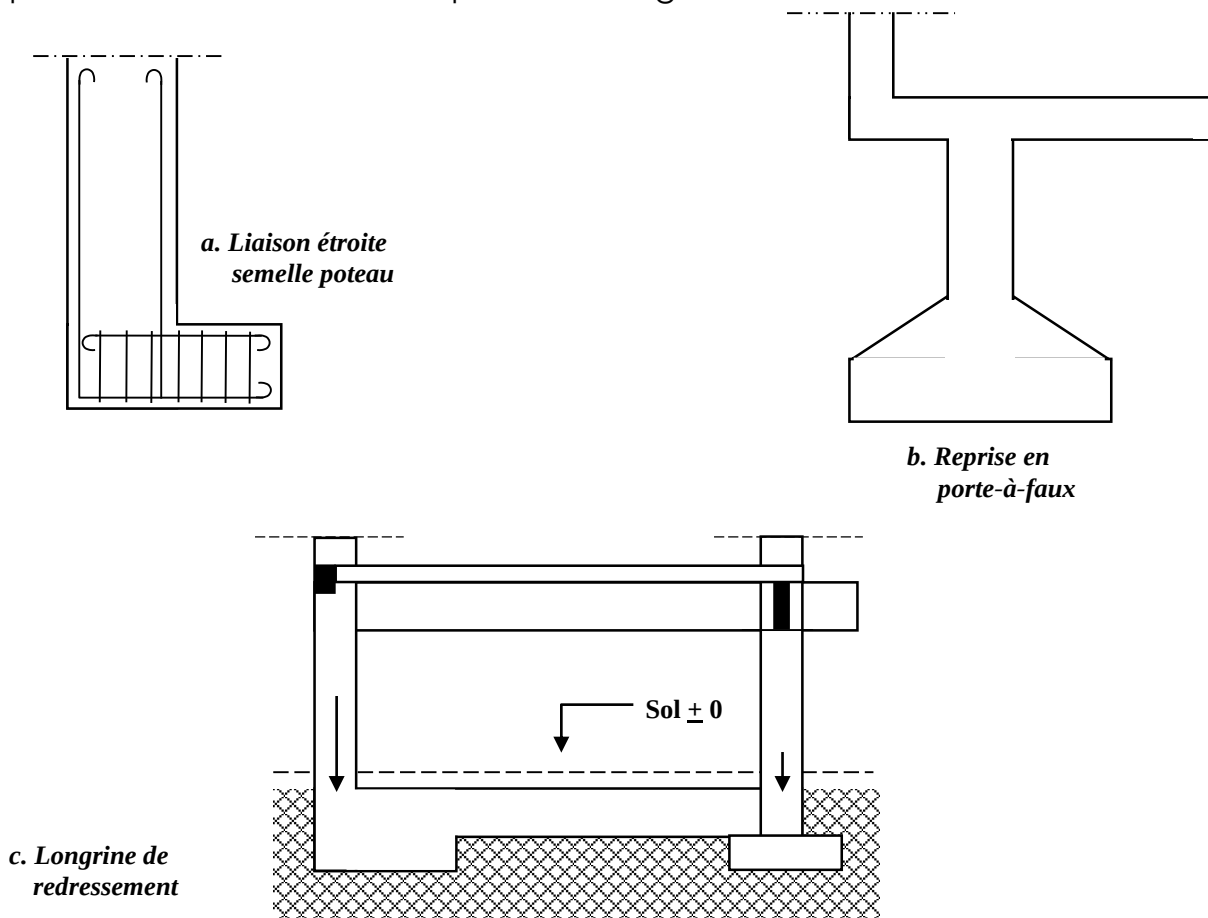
Semelles excentrées avec longrine de redressement
